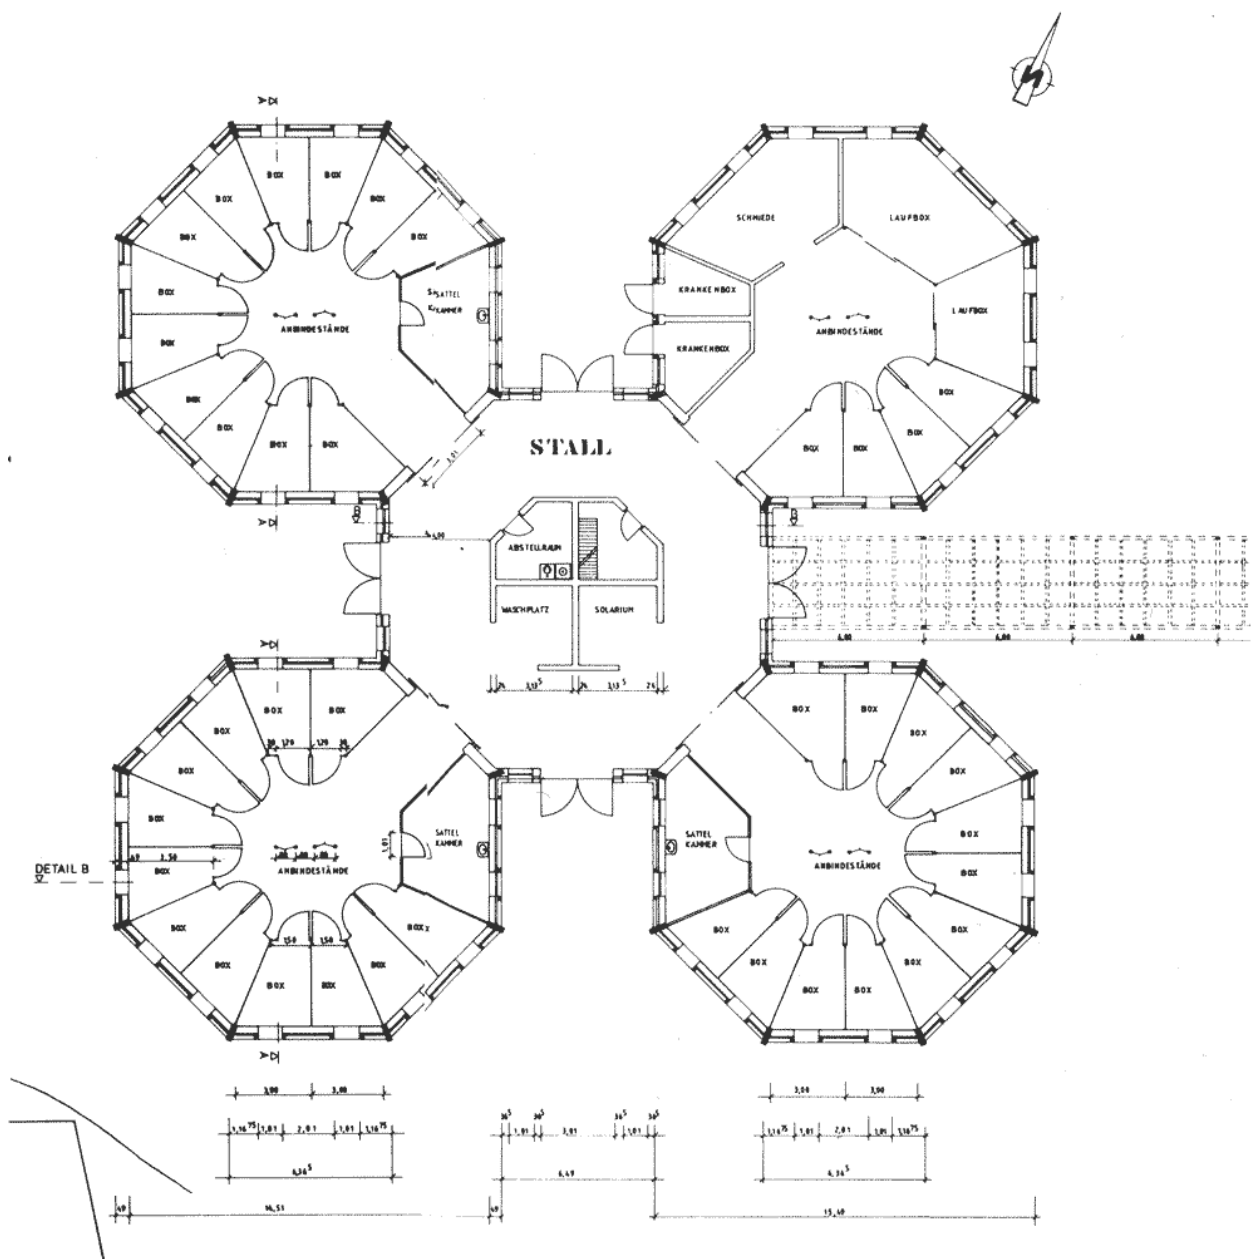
Grundriss Achteck-Stallanlage
